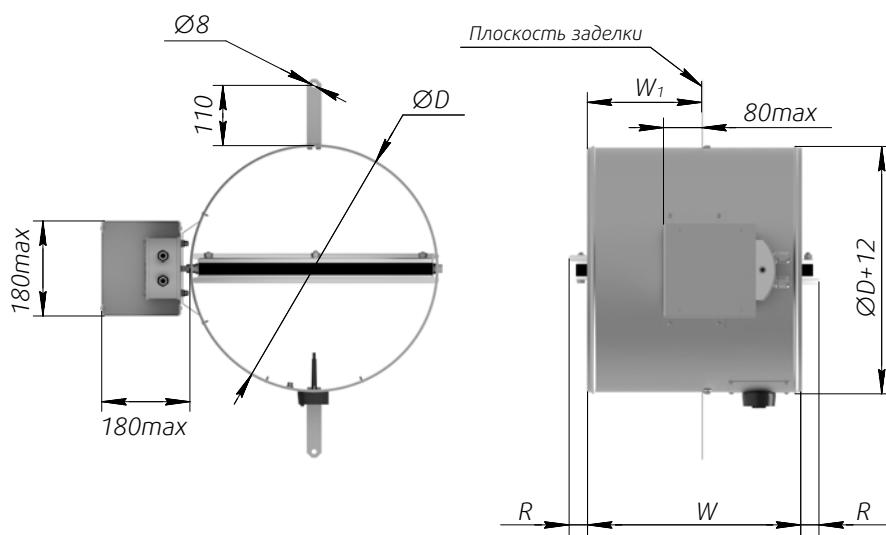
в. Размеры ниппельного клапана HELMER, EI60 (с возможностью стеновой заделки)
